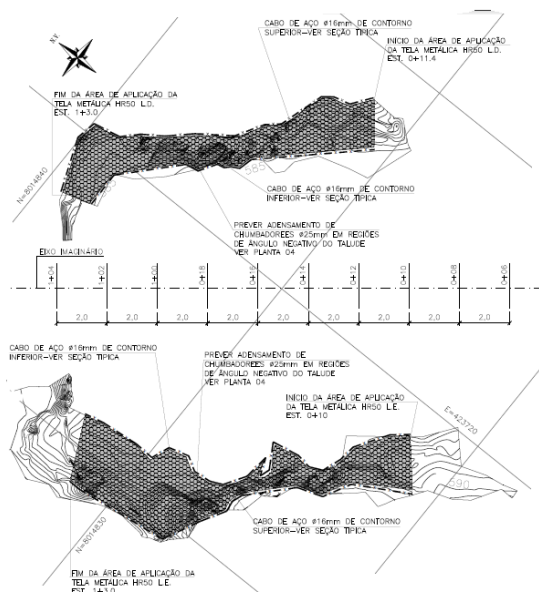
Vista em planta da região de aplicação da tela metálica com malha de chumbadores. Local do tratamento para estabilização do maciço rochoso.
